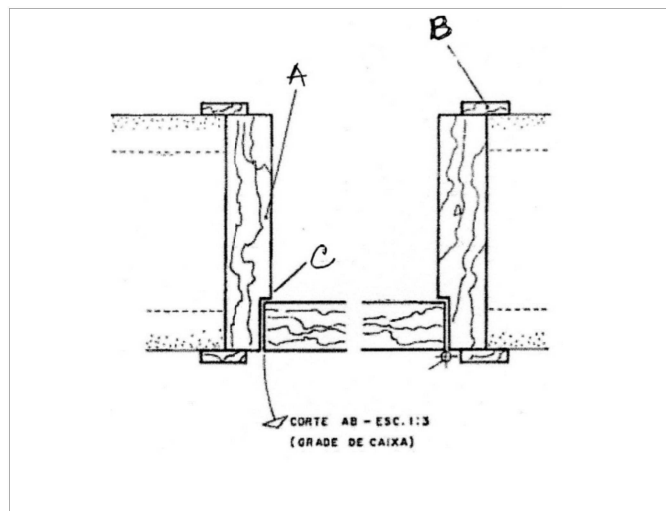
Detalhe de corte AB de porta (planta baixa). Montenegro (1997)
